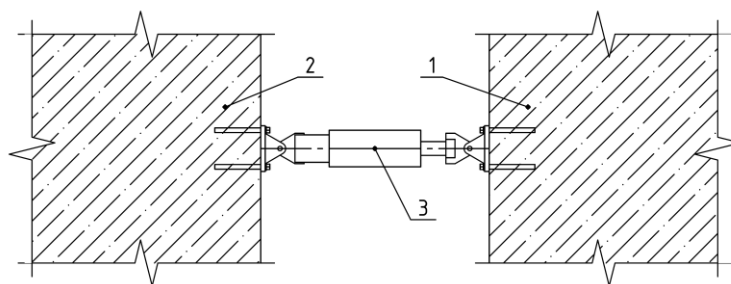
Демпфирующее устройство между подвешенной и основной частями здания: 1 – несущий ствол; 2 – плита перекрытия; 3 – демпфирующее устройство
